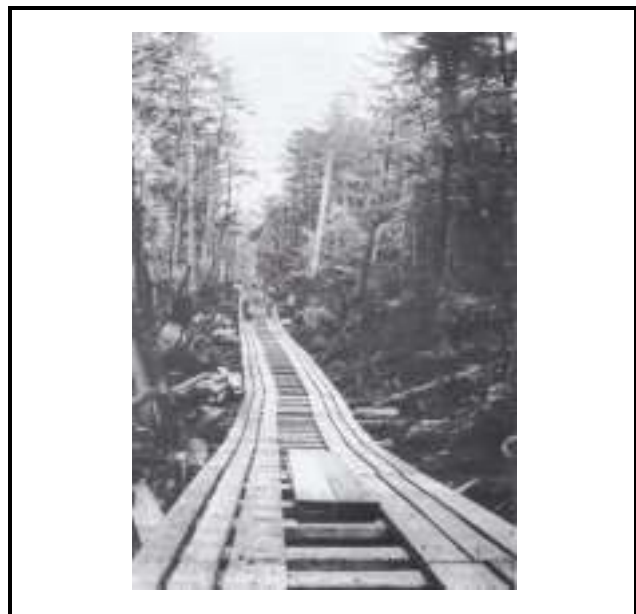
Le personnel des unités de construction et d'entretien construit une route de madriers pour rejoindre un site éloigné
